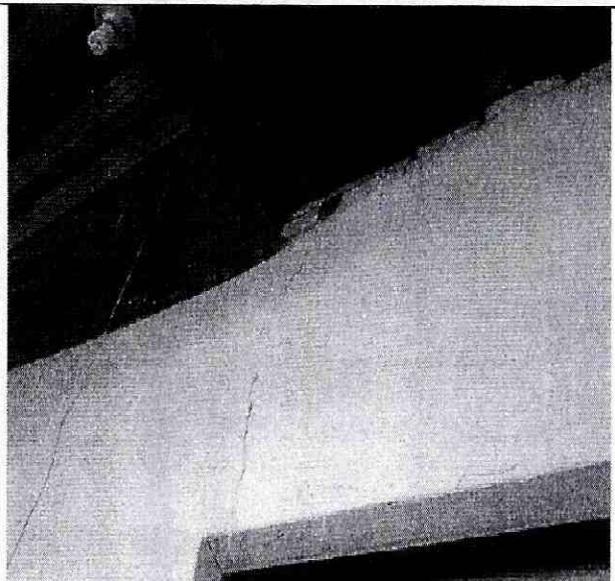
Agrietamiento en el dintel de muro del segundo piso.
